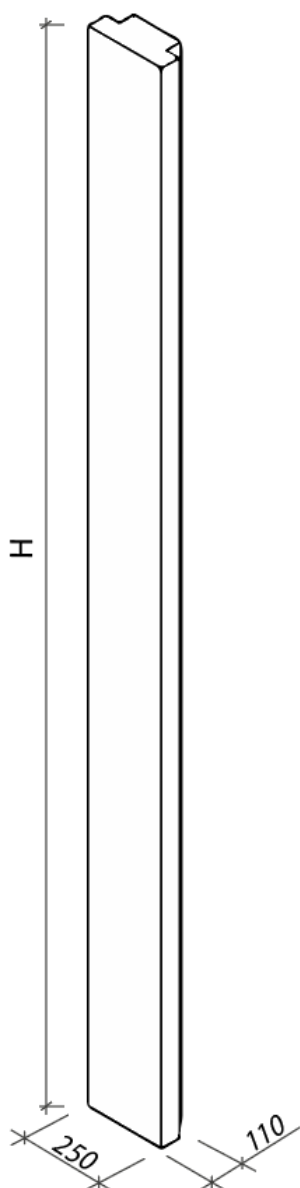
Sloupek dělený průběžný – (rozměry včetně sloupkové desky)
